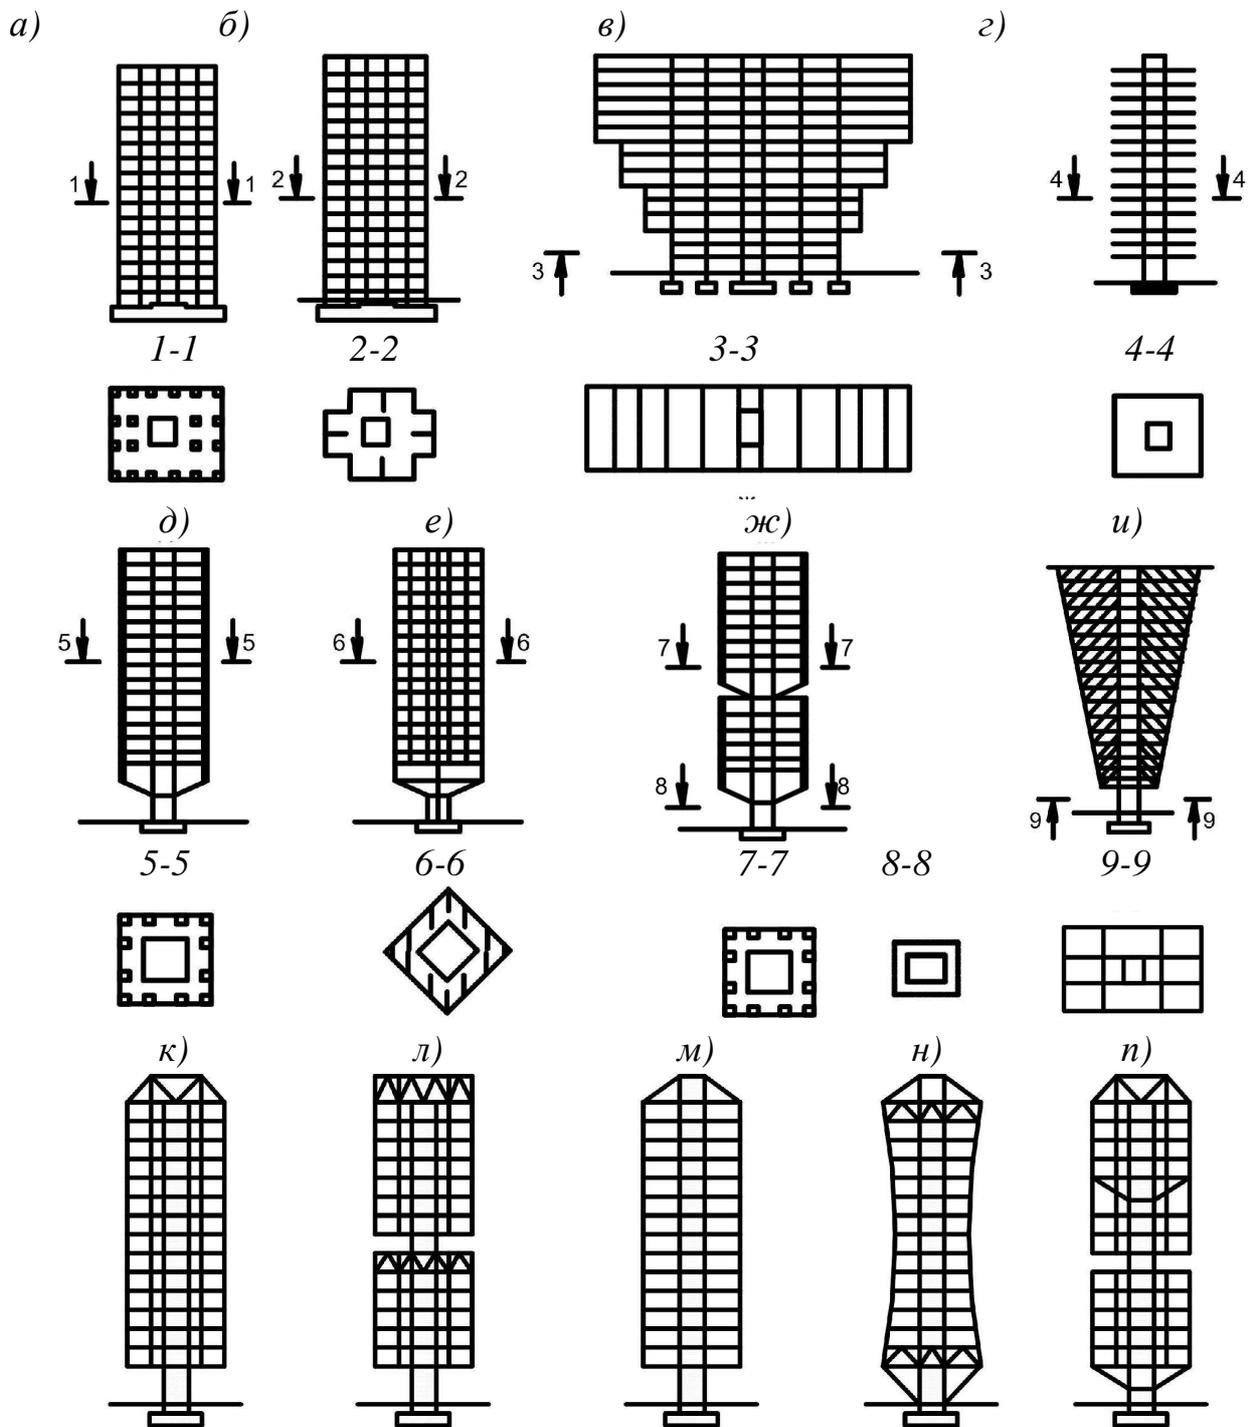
Варианты конструктивных систем со ствольной схемой обеспечения пространственной жесткости высотных зданий: *а* – каркасно-ствольная; *б* – ствольно-стенная; *в* – каркасно-ствольная с консольными этажами; *г* – ствольная с консольными конструкциями перекрытий каждого этажа; *д*, *е* – ствольная с консольным поясом в нижнем уровне; *ж* – с консольными поясами в двух уровнях; *и* – с трапециевидной консолью на высоту здания; *к* – с подвеской перекрытий к консольному оголовку в верхнем уровне; *л* – то же, к оголовку и промежуточному поясу; *м* – то же, к вершине ствола на оттяжках и подвесках; *н* – с предварительно напряженными подвесками, работающими совместно со стволом на горизонтальные воздействия; *п* – комбинированная система с консольными поясами и подвесками
